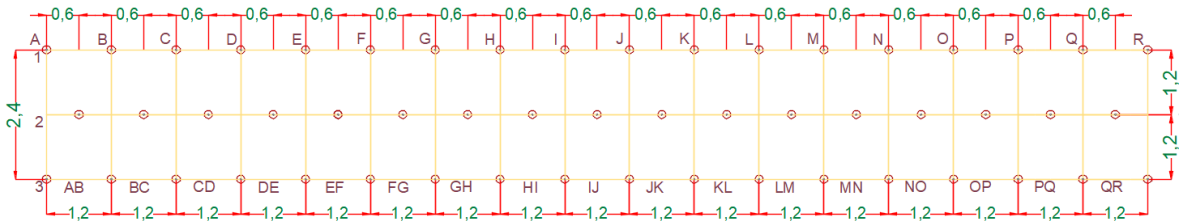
Malla de perforación para bulones en Muro y estribo existente
